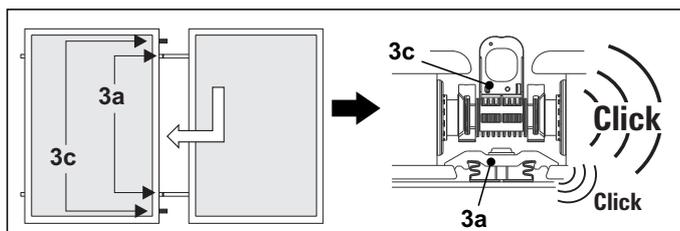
Fase di lavoro 6 con 2 e più collettori
